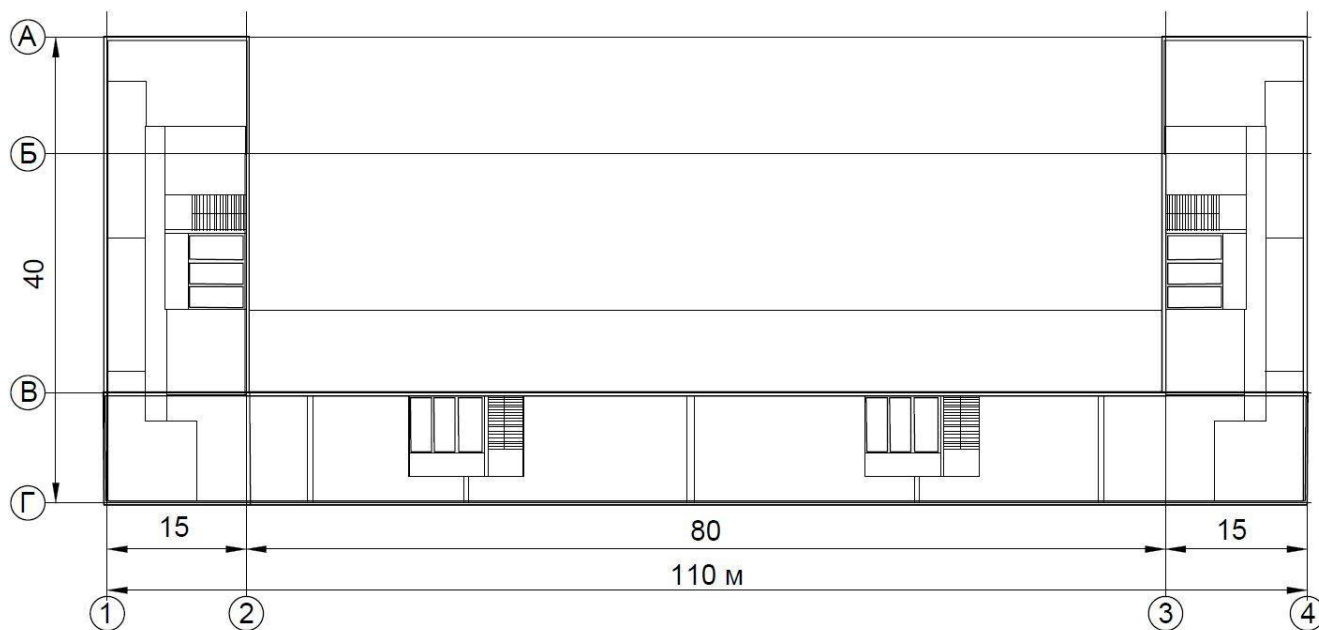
План подвального этажа зданий по адресам: г. Москва, Ленинский проспект, дом 78
